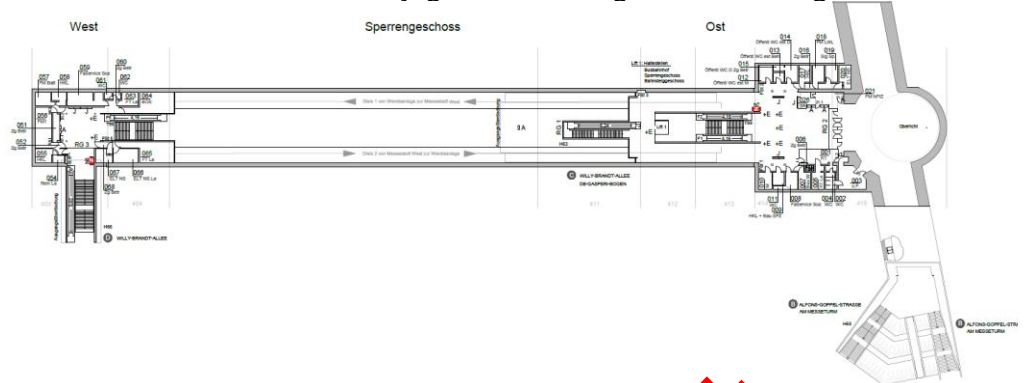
Grundriss Sperrengeschoss MS
